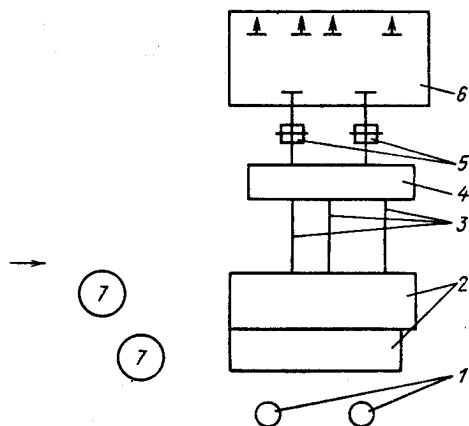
Вариант размещения основного оборудования на площадке ТЭЦ с отдельным зданием ГРУ:
